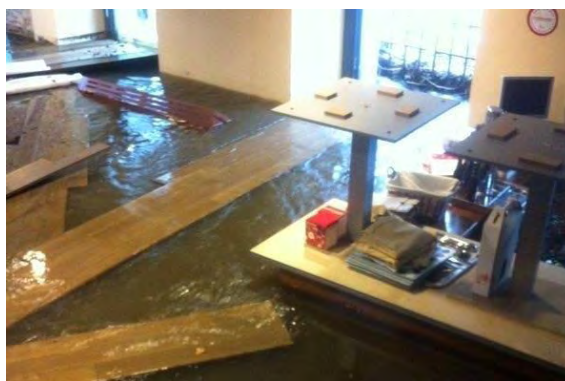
Efectos de la inundación en la planta baja del bar-restaurante Ingenio Chico, con tarima flotante de madera levantada y los elementos del mobiliario sumergidos (fuente: Segovia al Día. www.segoviaaldia.es Autor: Javier López Alarma).
